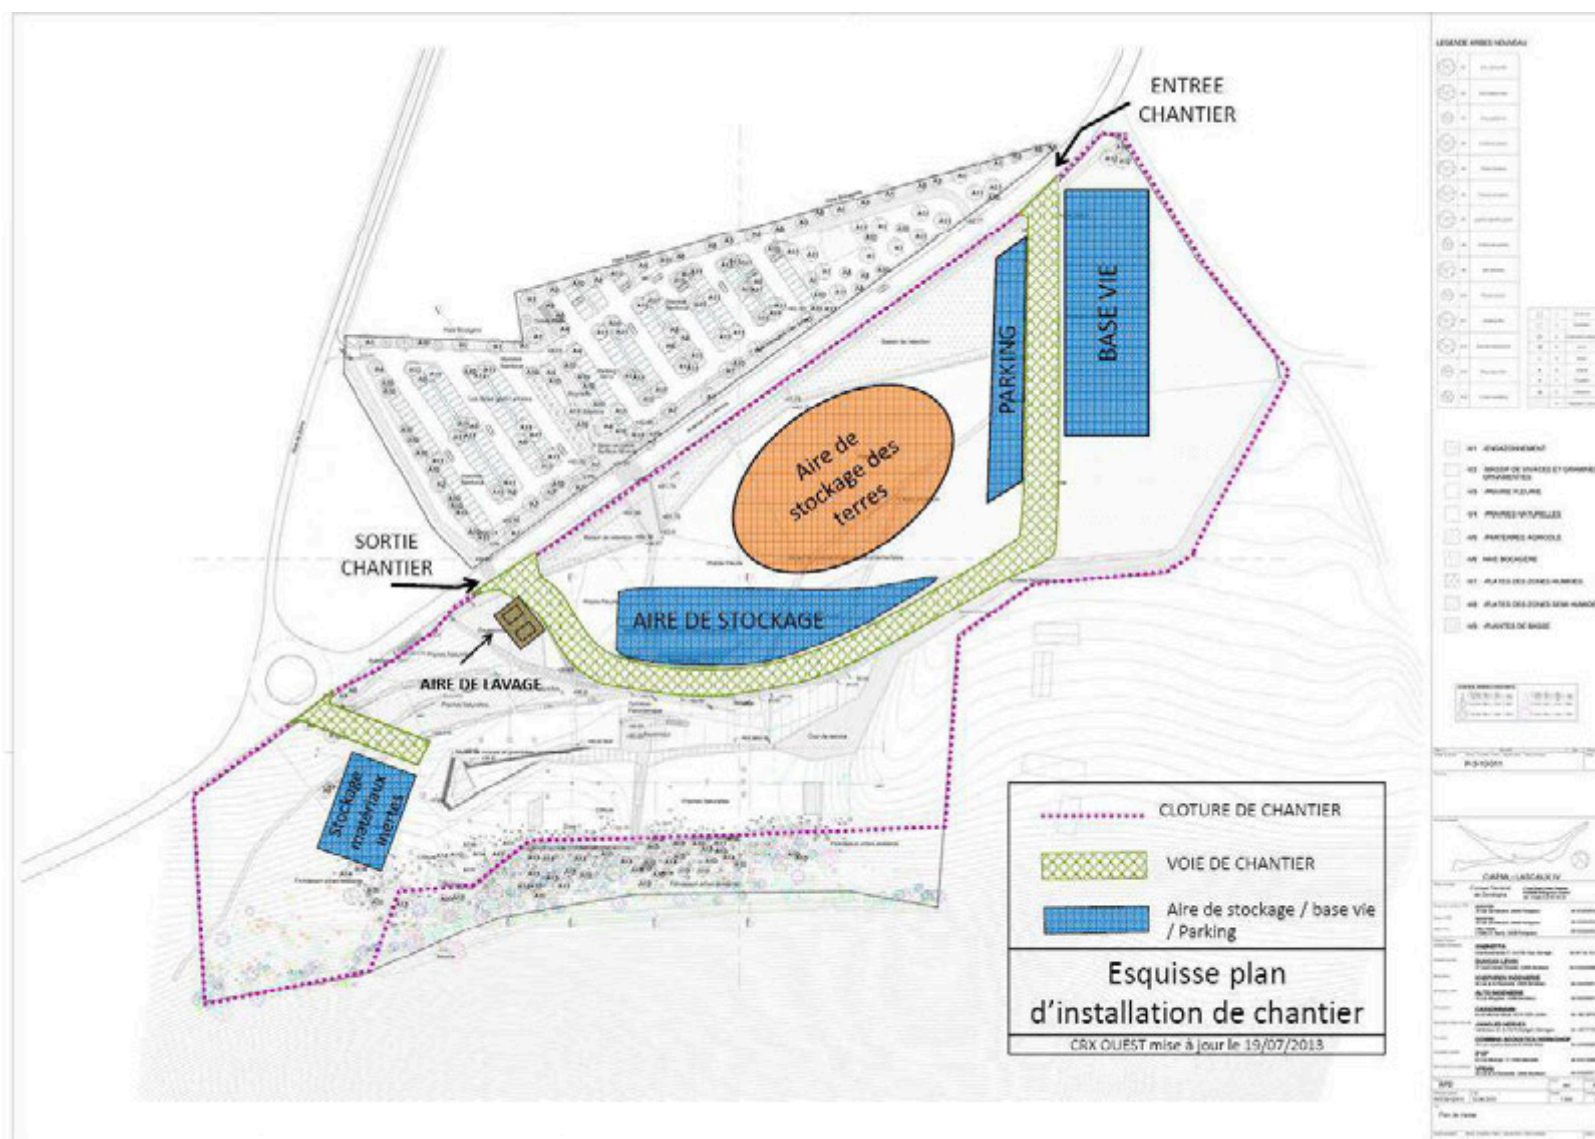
Esquisse plan d'installation de chantier (Source : CRX OUEST, juillet 2013)
